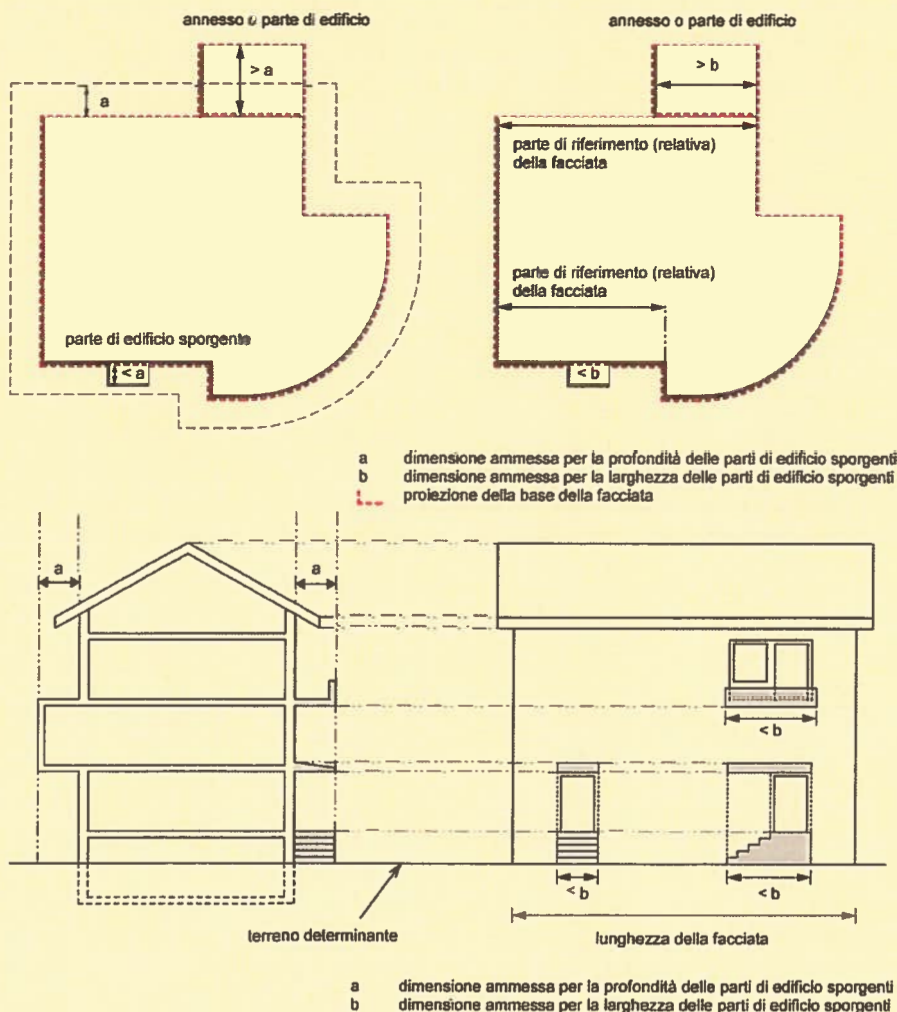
Parti di edificio sporgenti (in sezione e in vista laterale)
